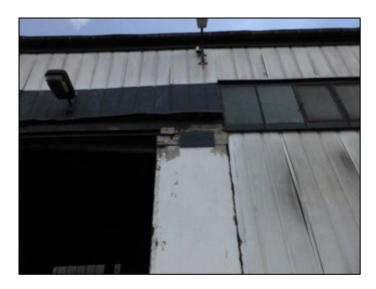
Große Lagerhalle: Abstehende Verblechungen und Attikabereiche als potentielle Quartiere spaltenbewohnender Fledermausarten
